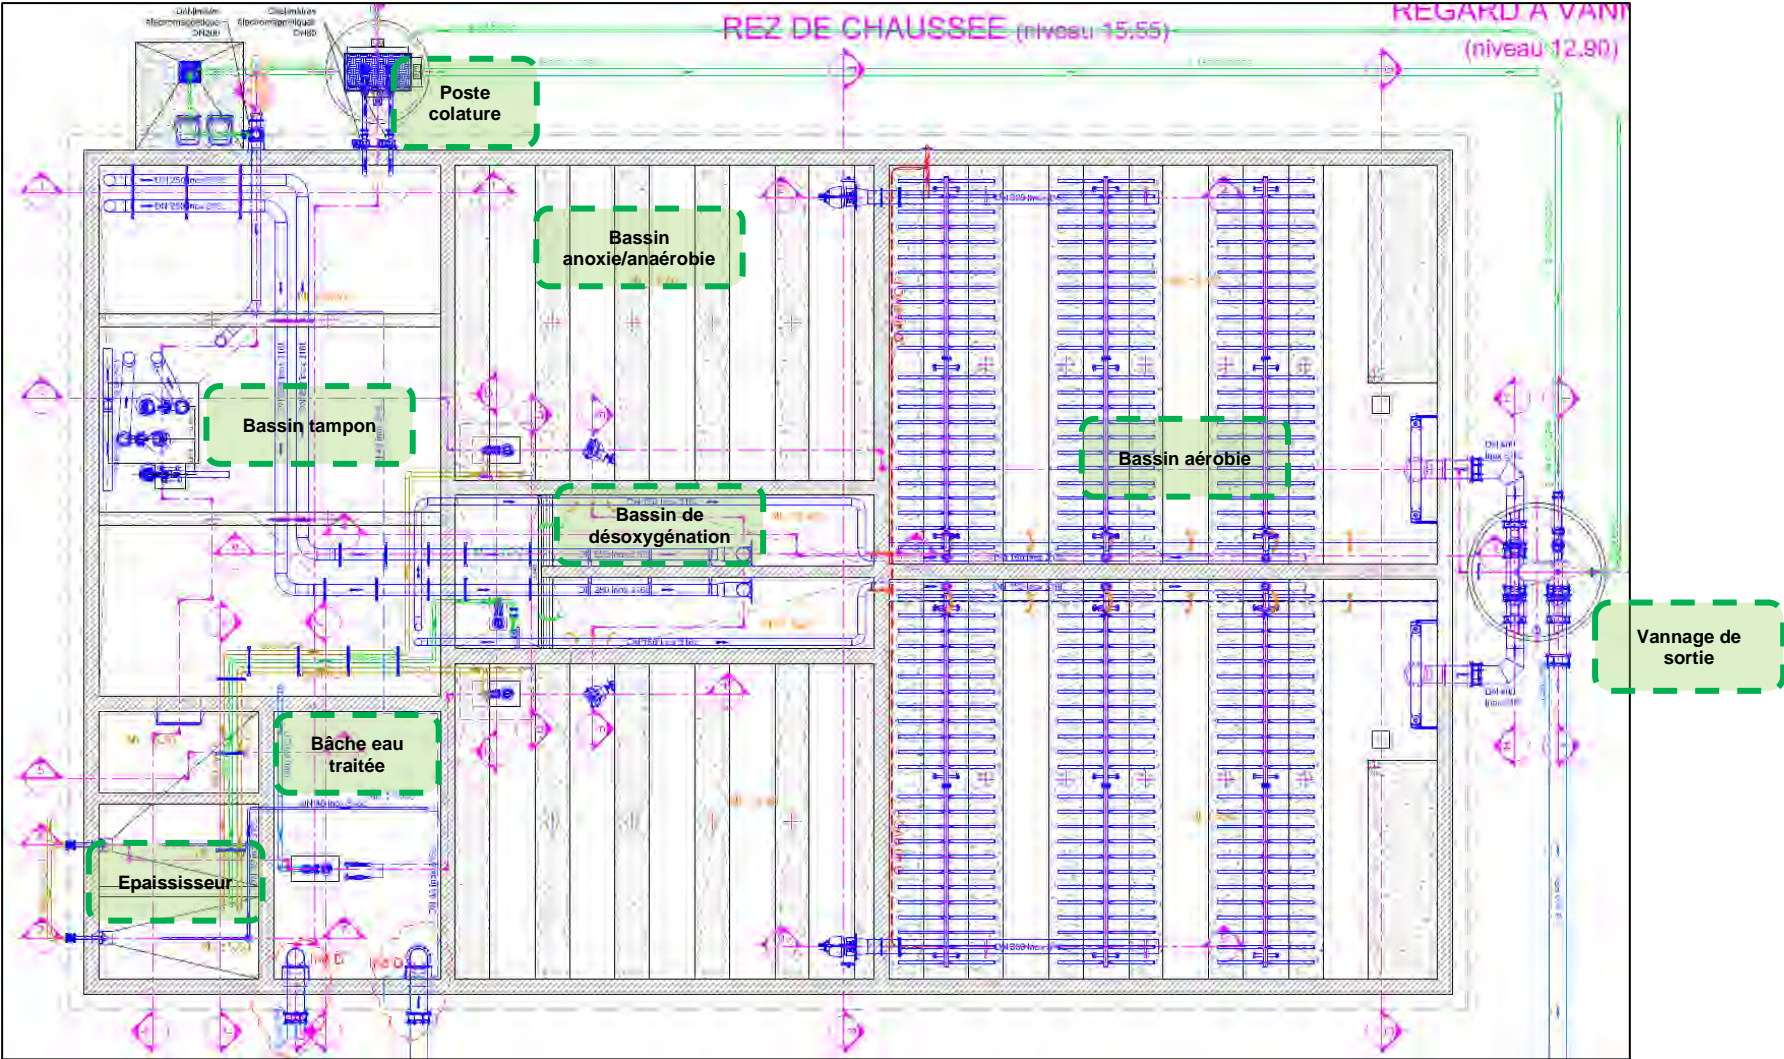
Plan masse du premier étage du bâtiment de l'Organica (Source : DOE)
